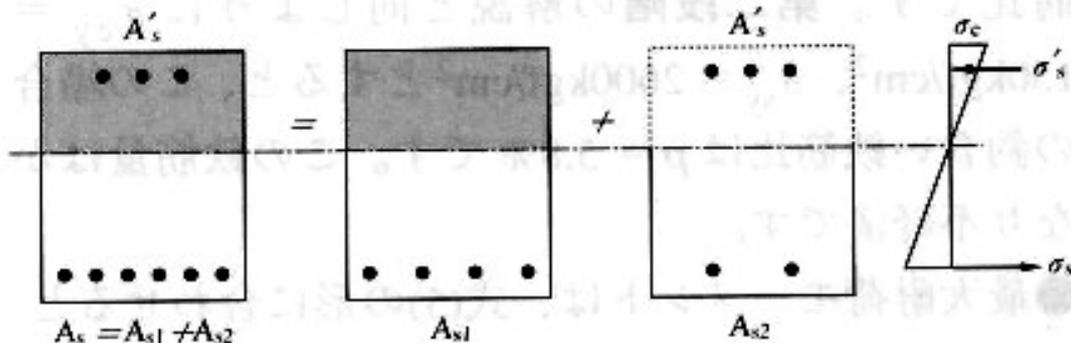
単鉄筋矩形梁+裸の鉄筋の合成
